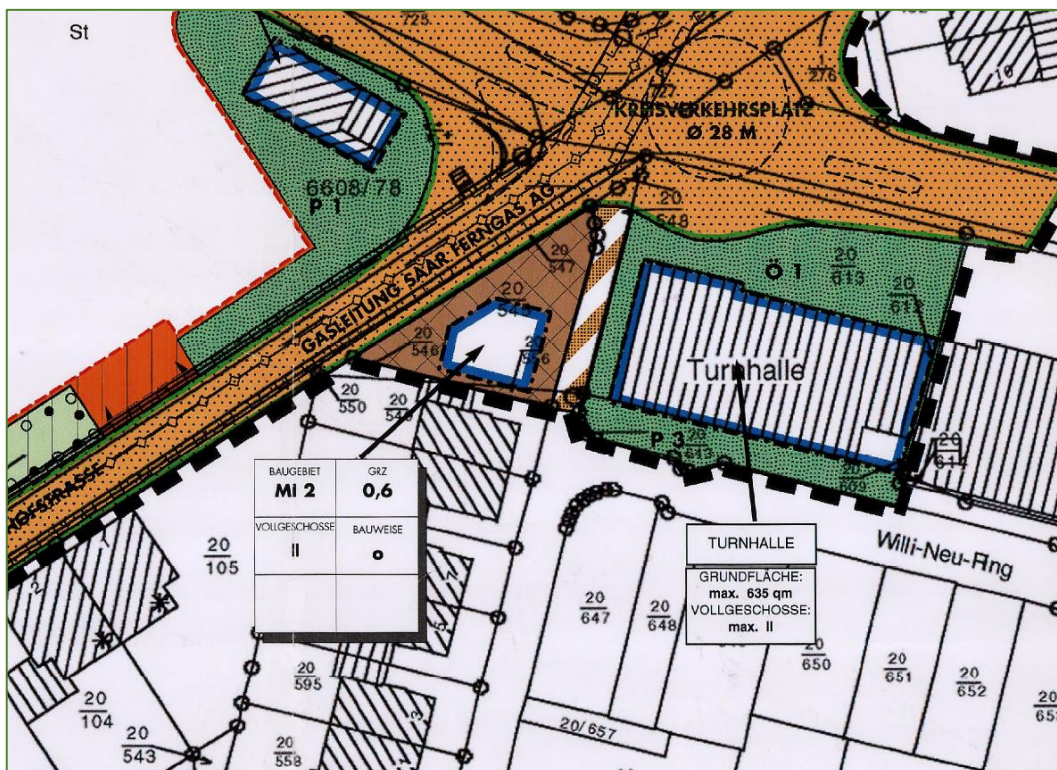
Bebauungsplan „Kaiserlinde“ (Quelle: Openstreetmap.org)
